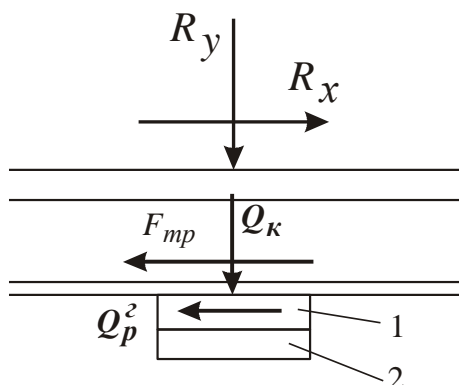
Расчетная схема для определения продольных сопротивлений системы 1: 1 – подрельсовая прокладка; 2 – подкладка
